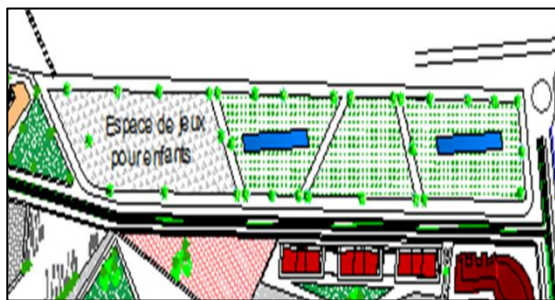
Vue en plan du jardin linéaire (entrée ouest de la ville)
